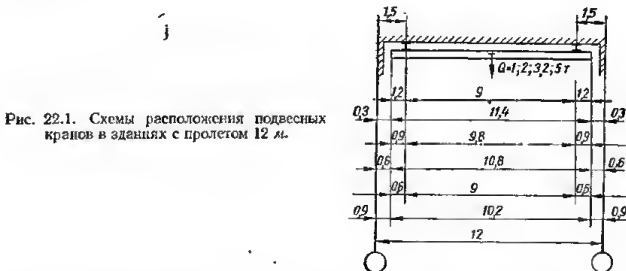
Схемы расположения подвесных кранов в зданиях с пролетом 12 м.
